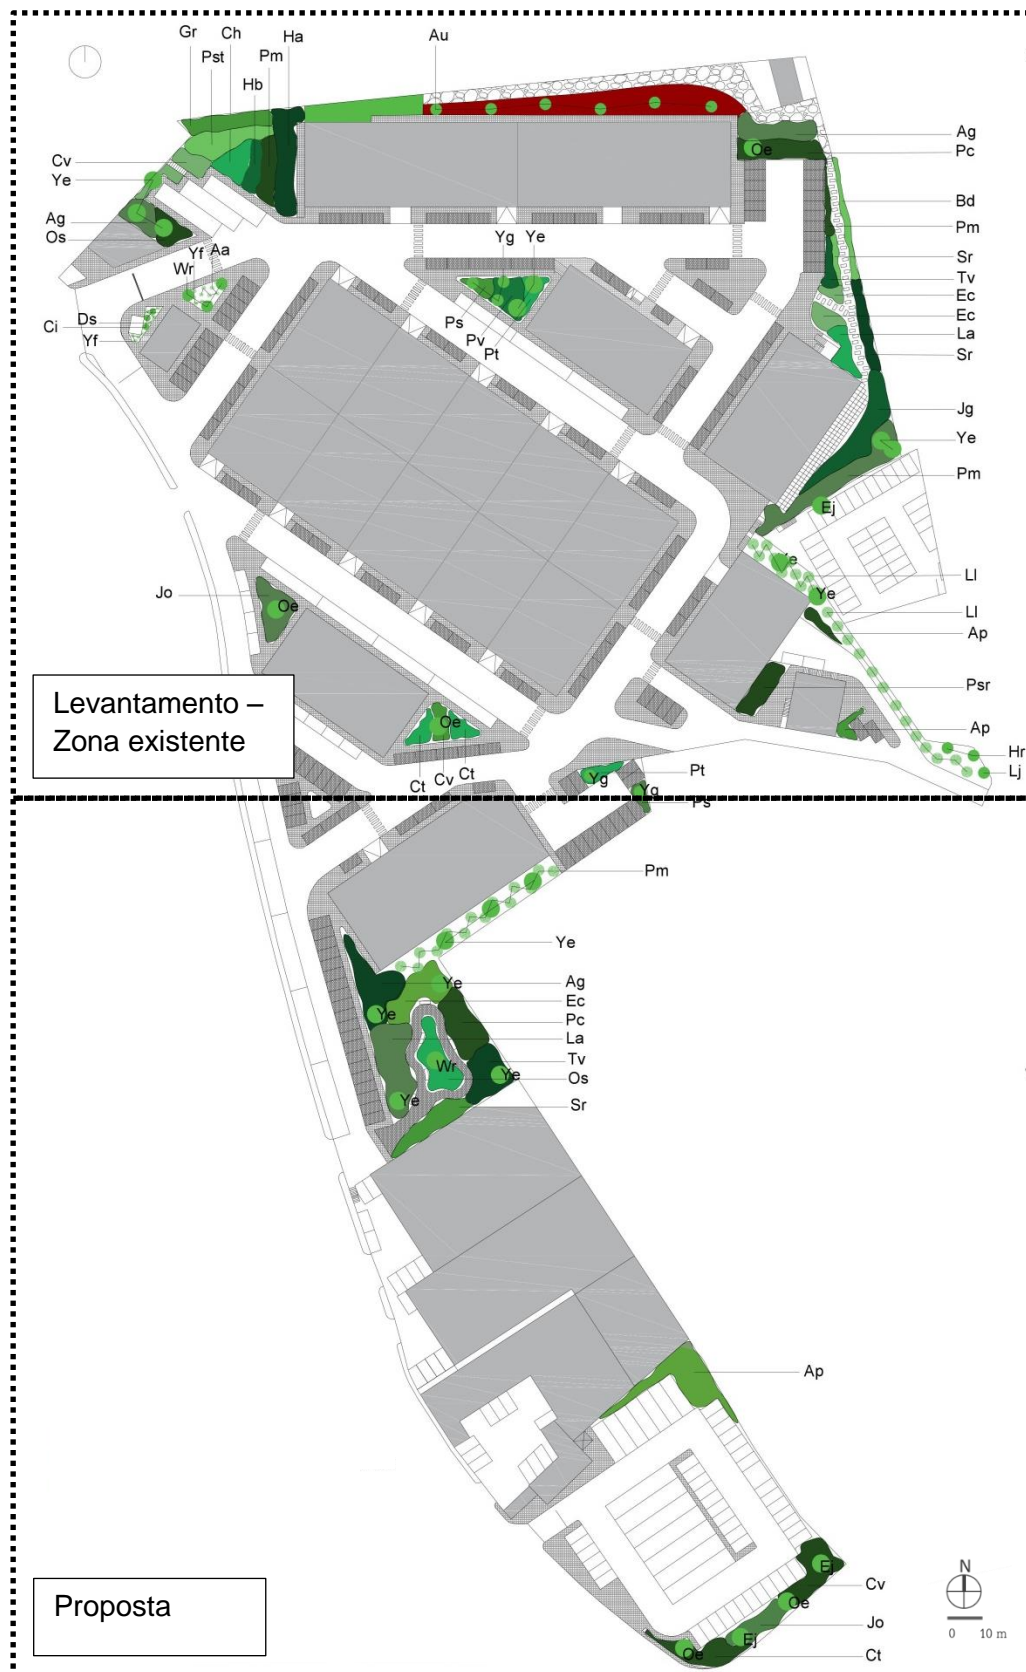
Plano de plantação proposto e de levantamento para o condomínio da Apametal (Fonte: autor)
